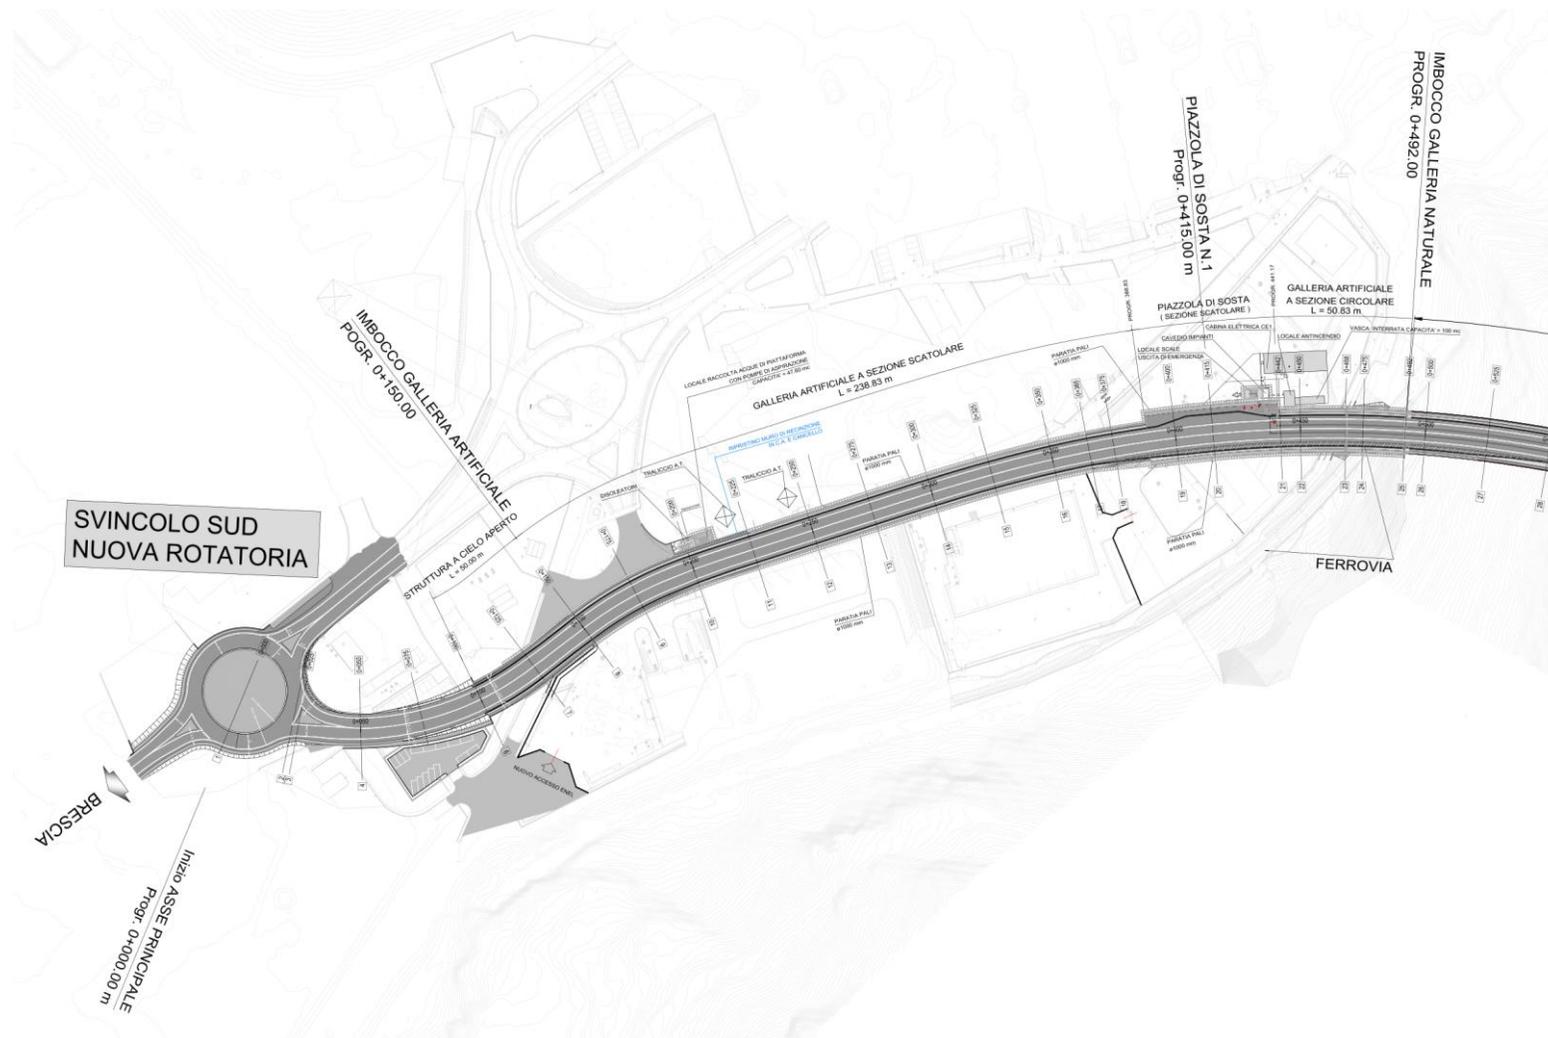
Schema planimetrico a piano strada - Tratto Sud
